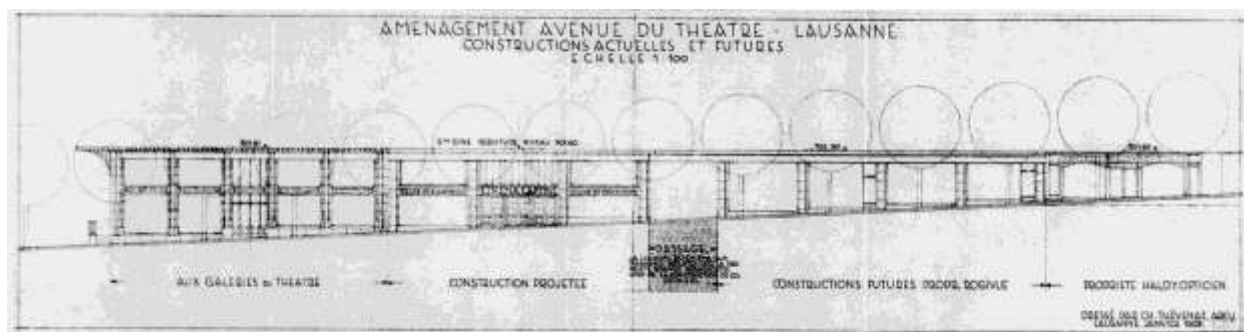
Aménagement de l'avenue du Théâtre, élévation, Charles Thévenaz architecte, janvier 1928 (AVL).
